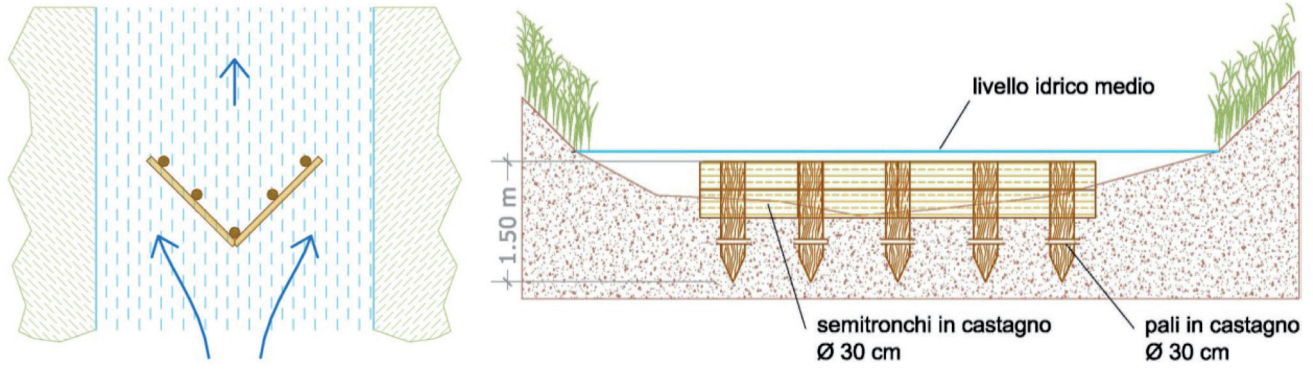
DEFLETTORE A V - INTERVENTO TIPO. PLANIMETRIA E SEZIONI.
